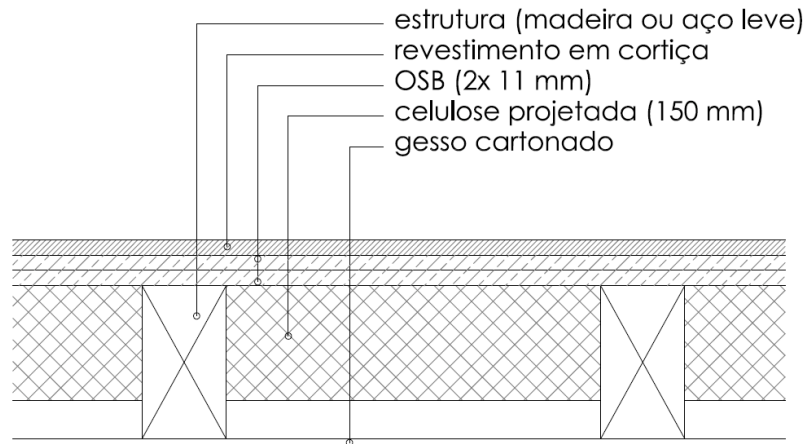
Laje de divisão entre o piso térreo e o primeiro piso (sem escala)
